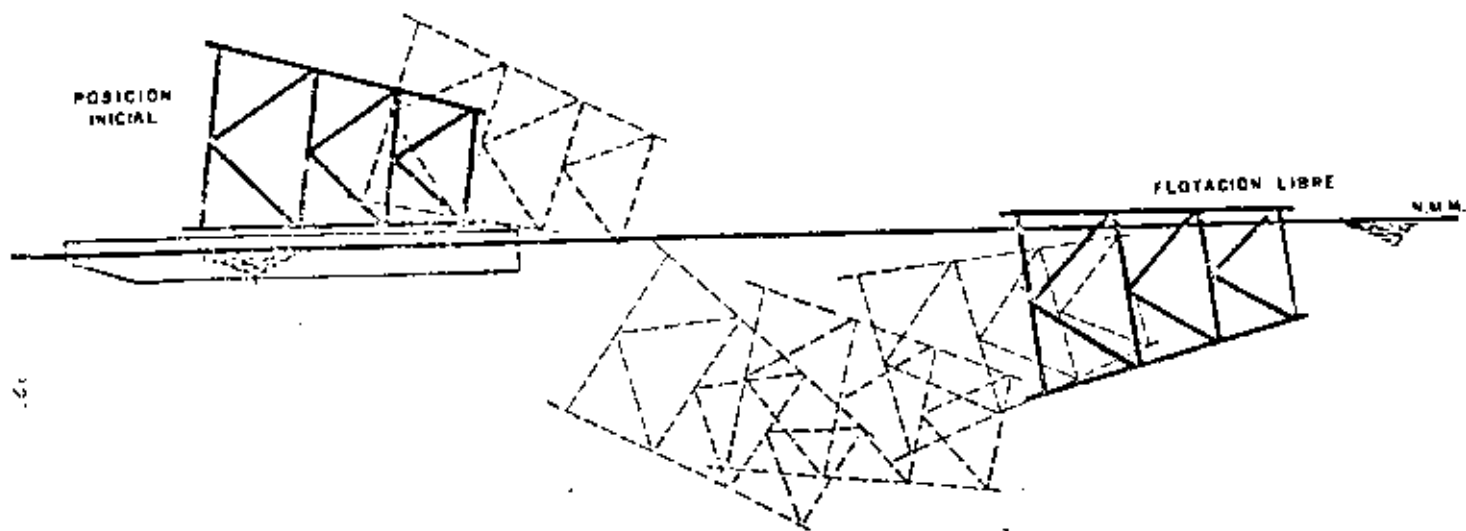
SECUENCIA DE LANZAMIENTO DE LA SUBESTRUCTURA
